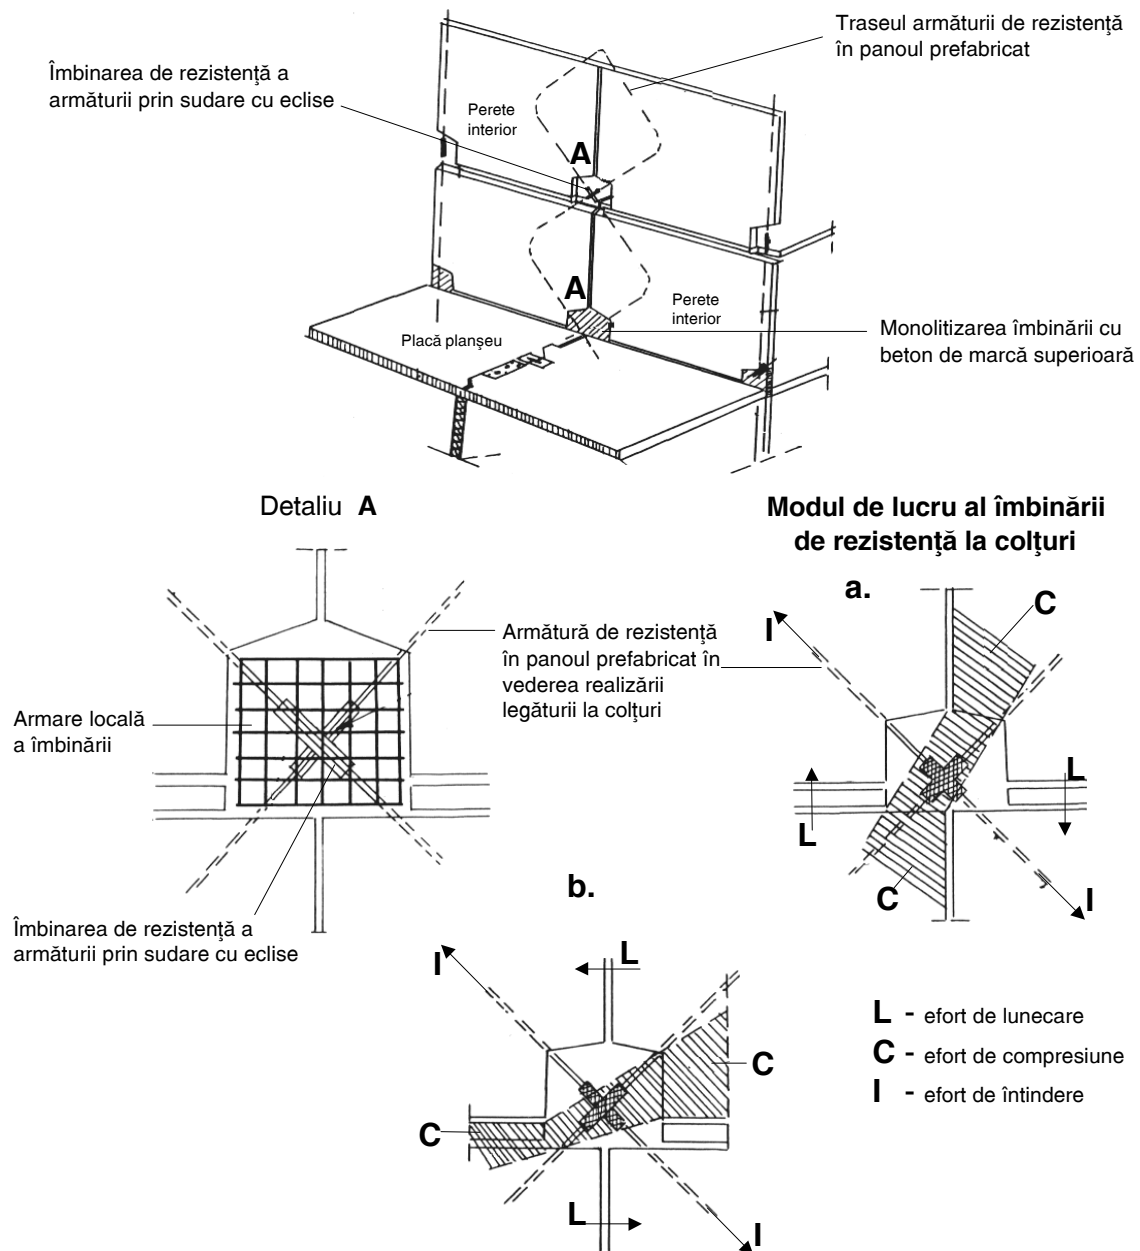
II.9 Pereți portanți din panouri mari prefabricate din beton armat. Îmbinare de rezistență la colțuri, alcătuire constructivă. Modul de lucru al îmbinării.
